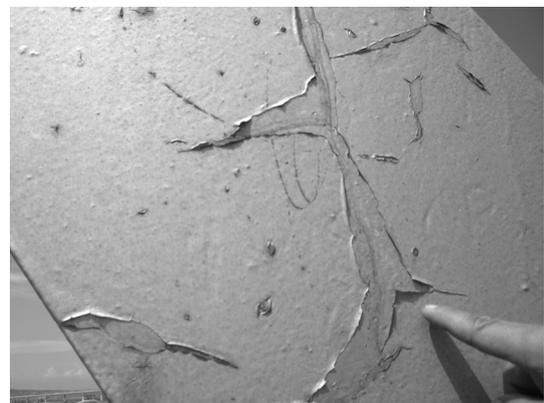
施工後3ヶ月で剥がれた再塗装塗膜
